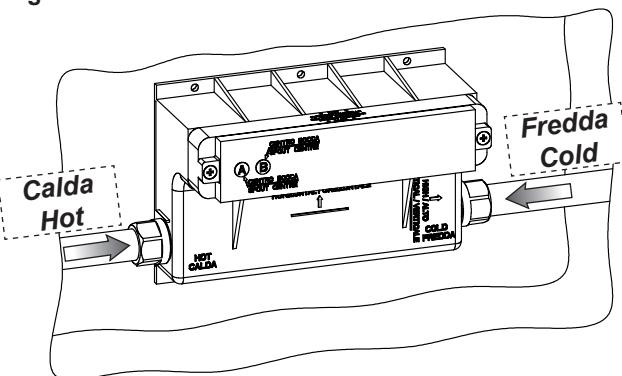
Для изготовления правильного проема под встроенный корпус необходимо проверить его реальные габаритные размеры и учесть минимальную и максимальную глубину встраивания, указанную на пластиковой защите, установленной на корпус.
